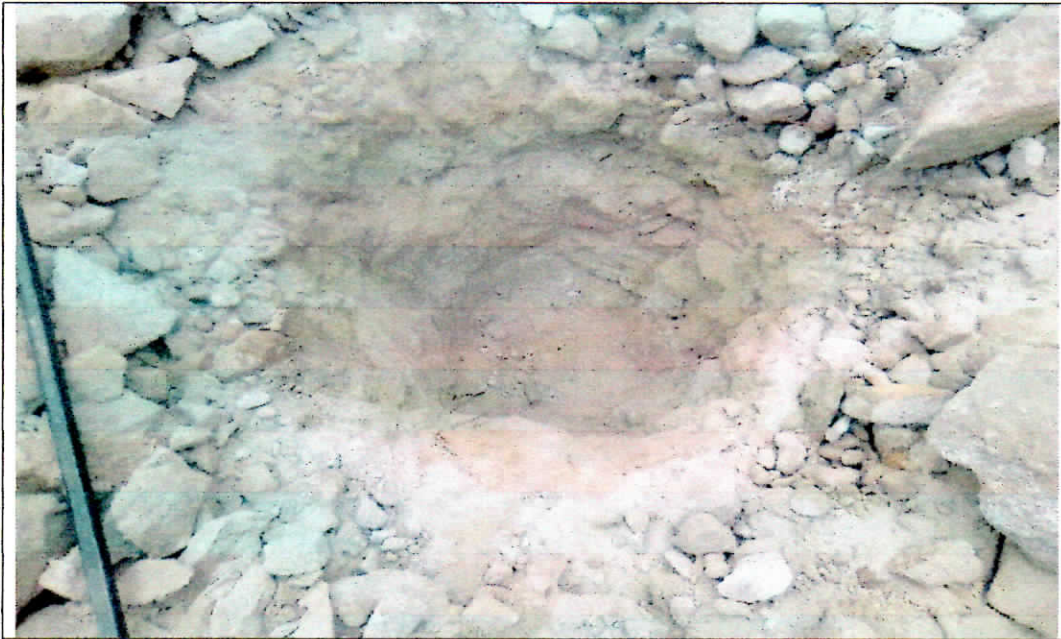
EXCAVACION DE CALICATA EN LA VIVIENDA PROYECTADA PARA LA EDIFICACION
